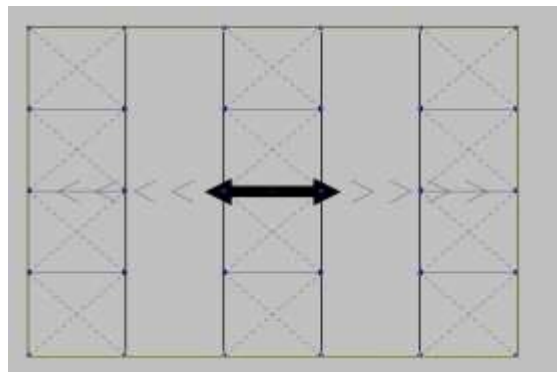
Distribución cargas cubierta. Fuente-CYPE
